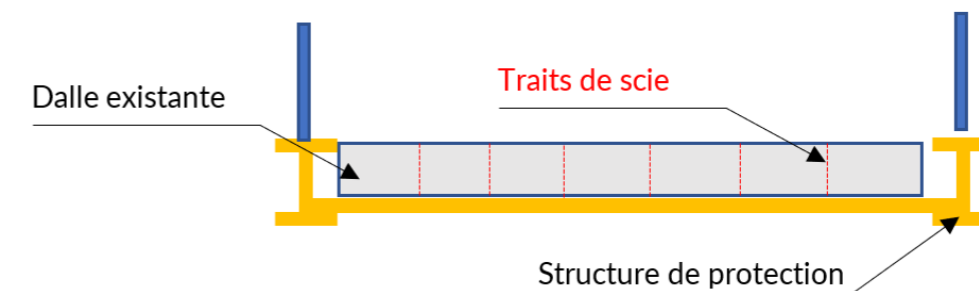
coupe transversale de la structure de protection phase travaux – Variante 1
